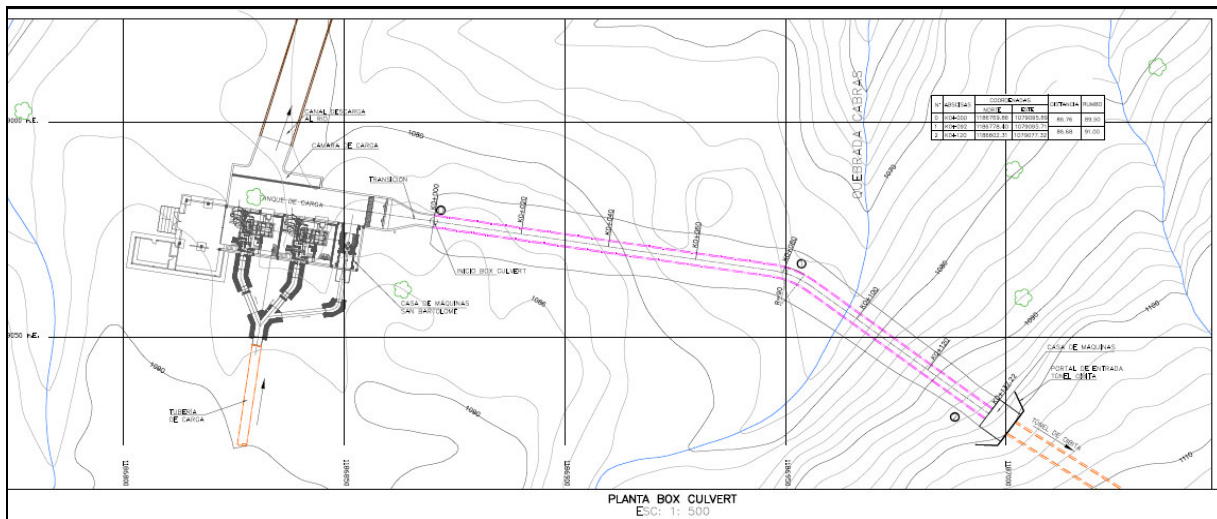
Planta del Box Couvert para el paso de la Quebrada Las Cabras
